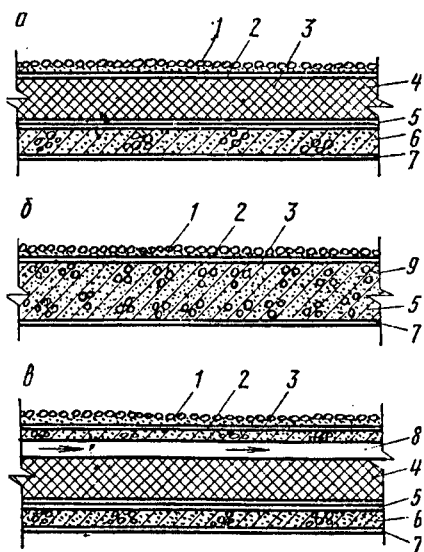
Принципова схема дахів, що мають спільну конструкцію з перекриттям: а – дах, що не має вентиляції, з теплоізоляцією; б – те ж саме, але сумісно з несучою конструкцією; в – дах, що має вентиляцію; 1 – верхній шар; 2 – рулонний килим; 3 – стяжка; 4 – теплоізоляція; 5 – пароізоляція; 6 – несуча конструкція; 7 – оздоблювальний шар; 8 – повітряний прошарок; 9 – теплоізоляційний несучий шар.
